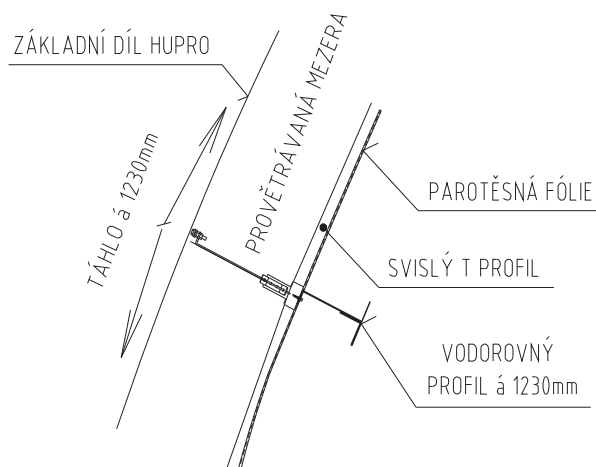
Způsob sestavení nosné konstrukce haly
